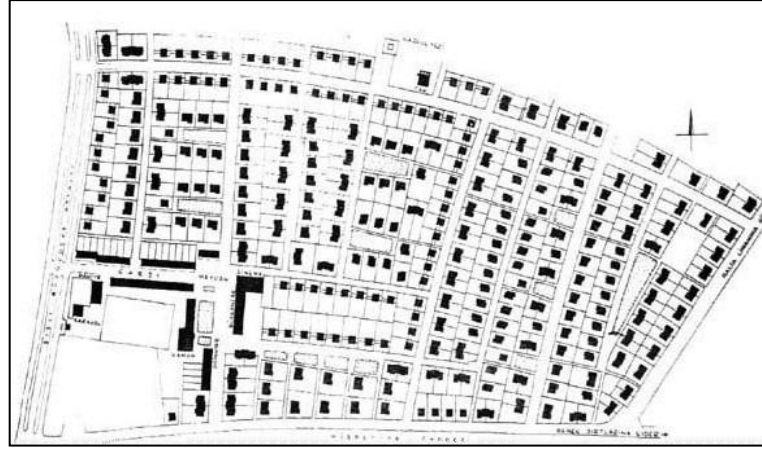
Levent Mahallesi vaziyet planı [127]
